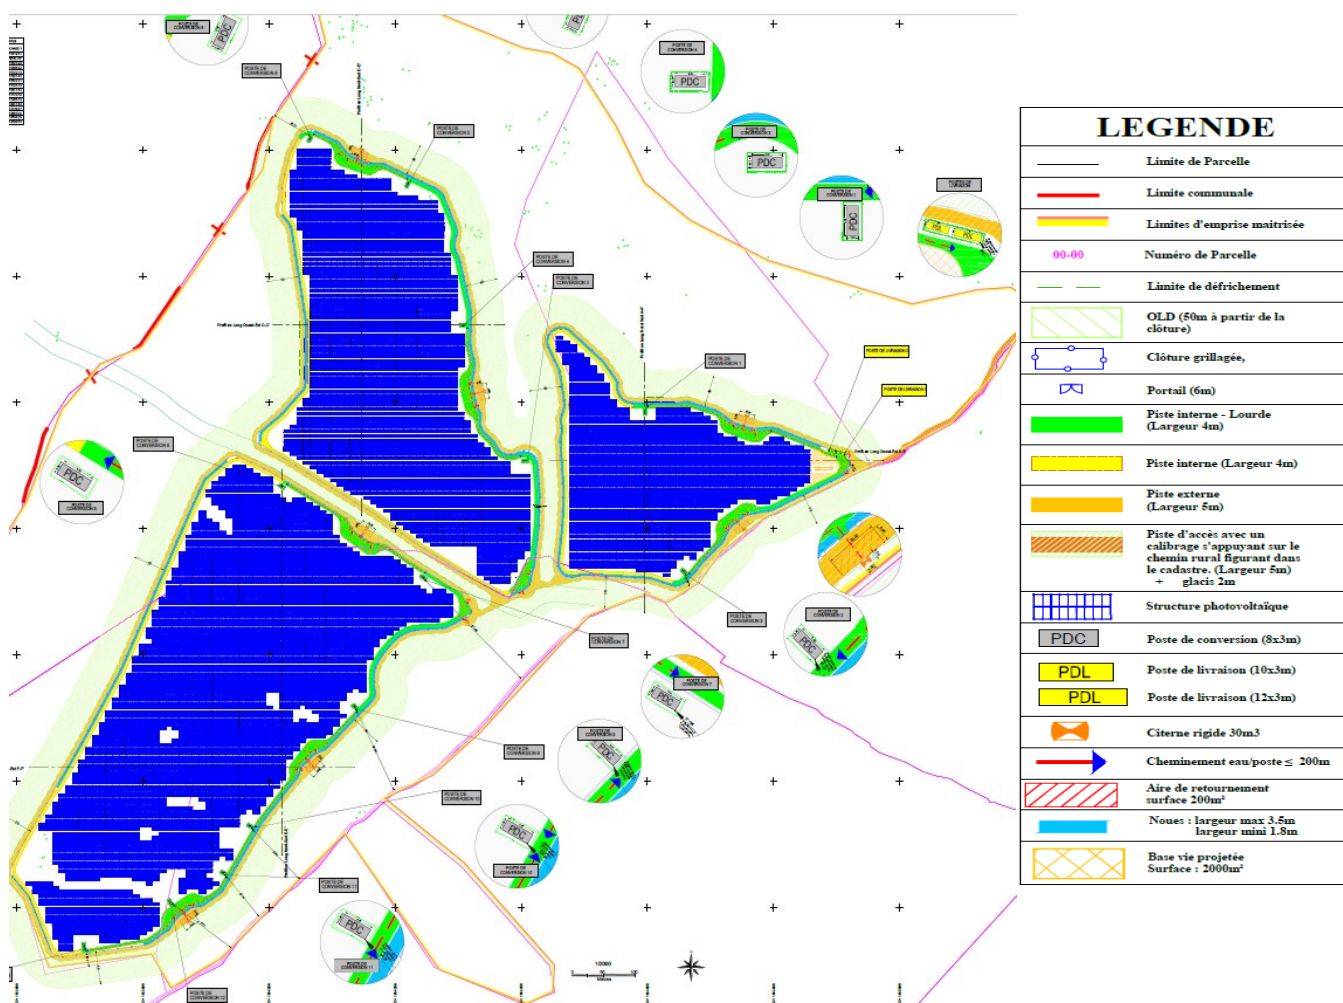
Plan de masse de la centrale photovoltaïque – Source : Permis de construire.
